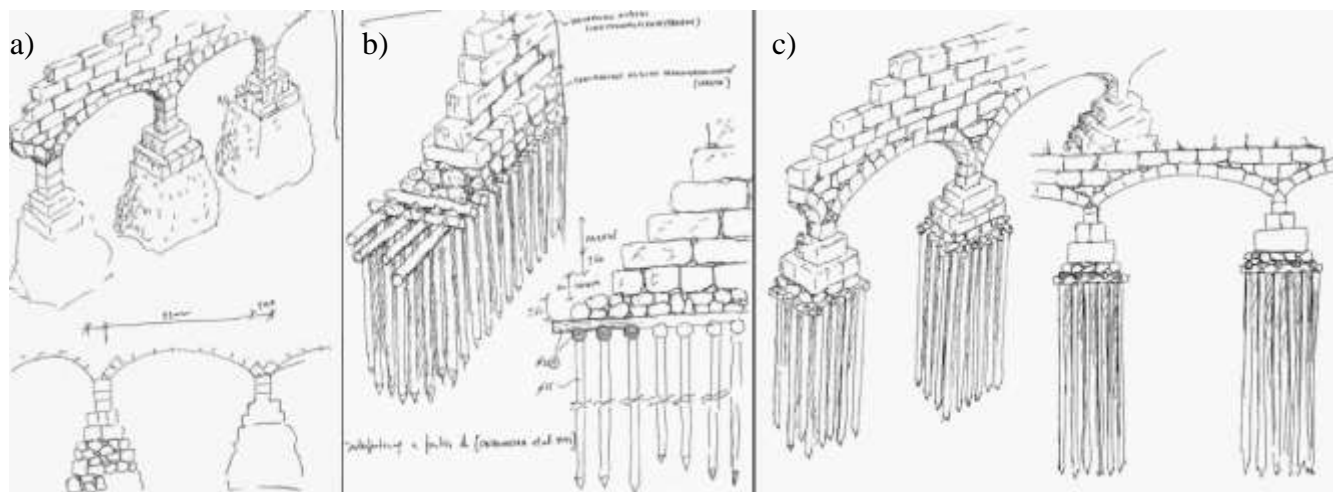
3 tipo de fundações: a) Fundação direta; b) Fundação indireta contínua; c) Fundação indireta pontual (Teixeira).
